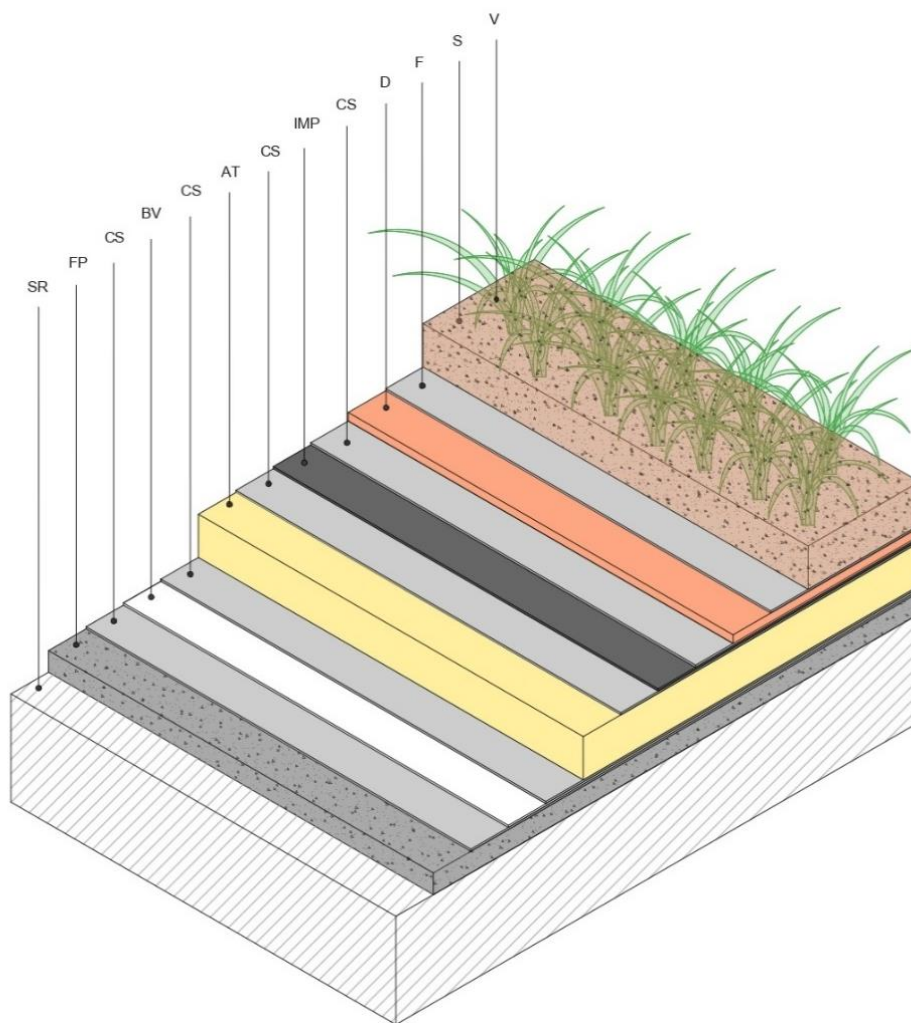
Detalle constructivo colocación capa drenante en cubierta convencional. Leyenda: V: Vegetación; S: Sustrato; F: Capa separadora filtrante; D: Capa separadora drenante; CS: Capa separadora; AT: Aislante; IMP: Lámina impermeabilizante; FR: Formación de pendiente; SR: Soporte.
